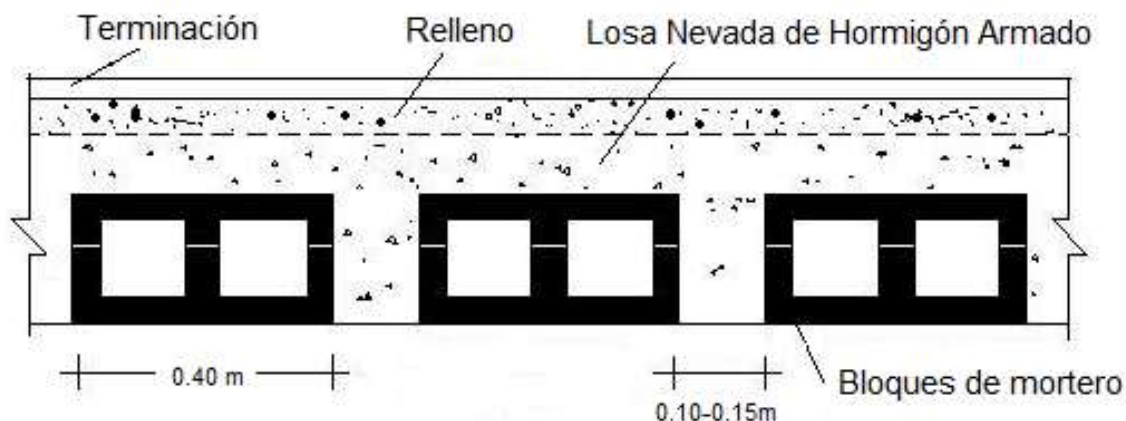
Esquema de losa nervada de hormigón armado mediante bloques de cerámica o de mortero.
